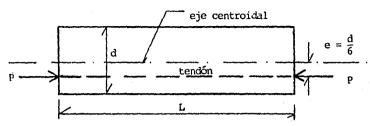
Viga rectangular presforzada por medio de un tendón excéntrico.
